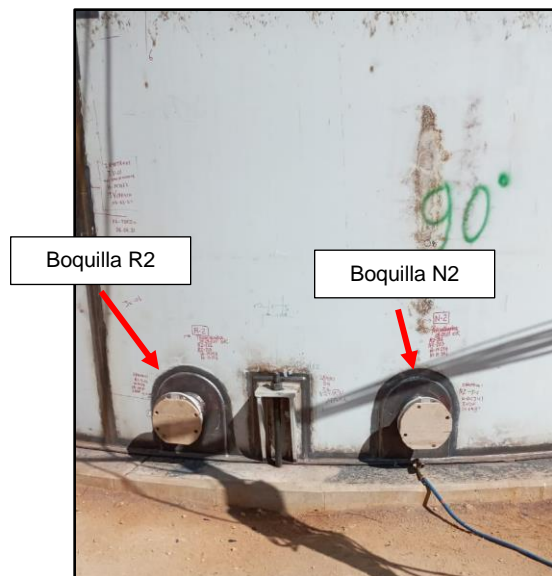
Silleta de anclaje y boquillas R2 - N2 armadas y soldadas
